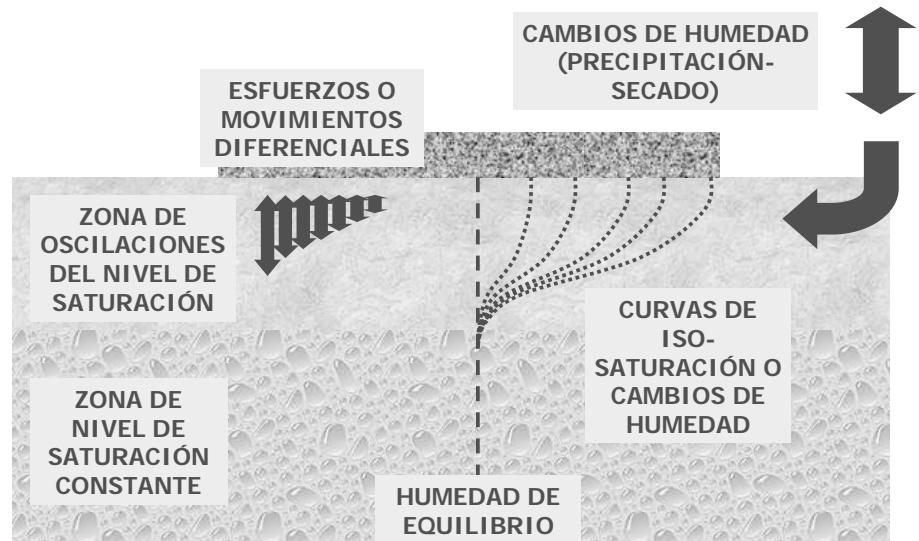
Efecto de saturación diferencial bajo una zona pavimentada
